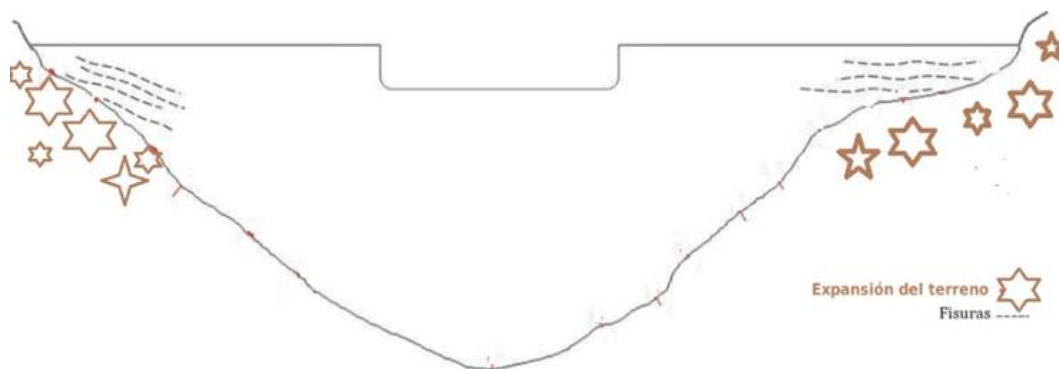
Representación teórica de empujes y fisuras (Pardo, 2014)
